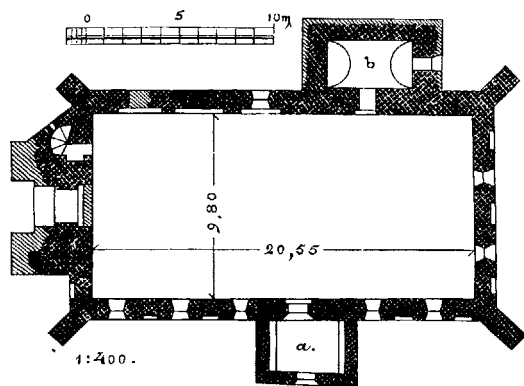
Niederzehren. Grundriss der Kirche.
